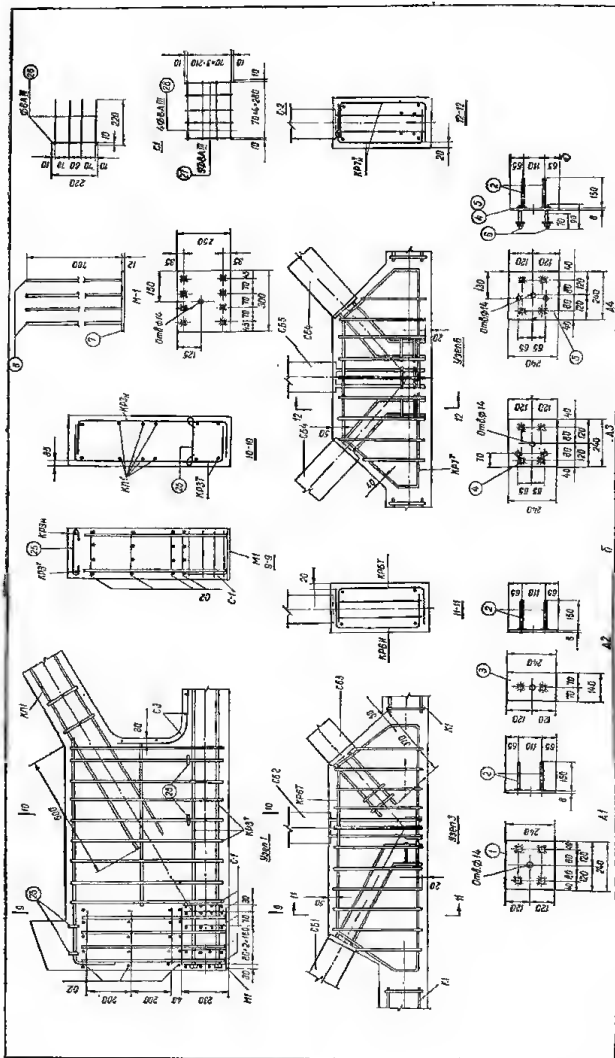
Рабочий чертеж фермы покрытия (геометрические размеры и армирование).
